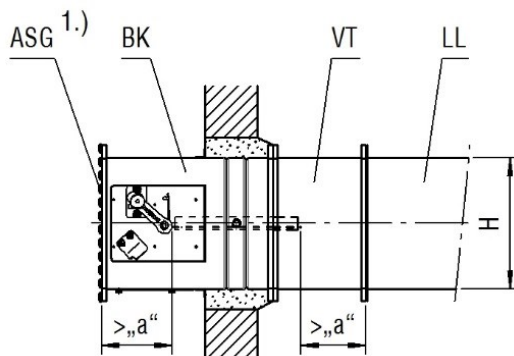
Exemple de raccordement d'un conduit d'aération situé d'un côté et une grille d'obturation protectrice
